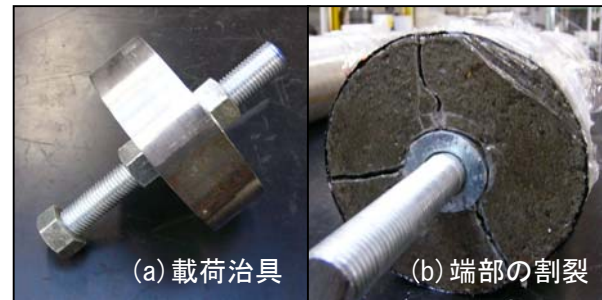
ナットを付けた治具と供試体端部の割裂状況
